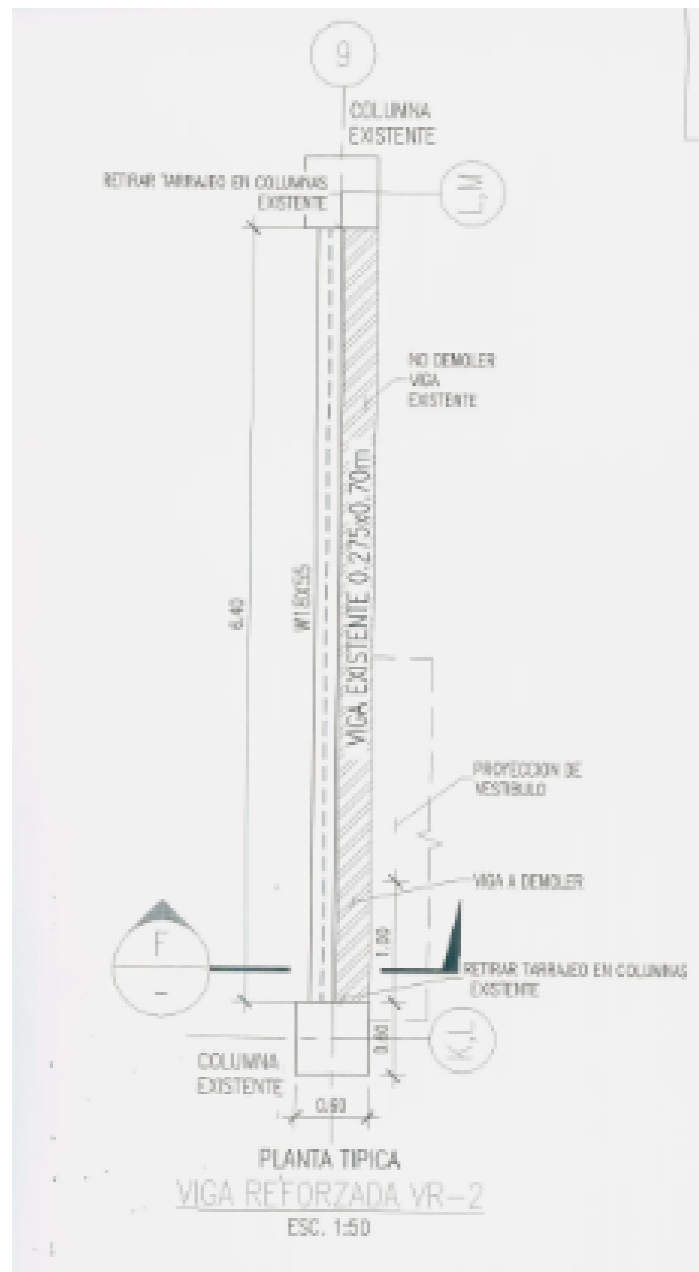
Vigas reforzadas. Fuente: Plano estructural del Expediente técnico del adicional N° 7
